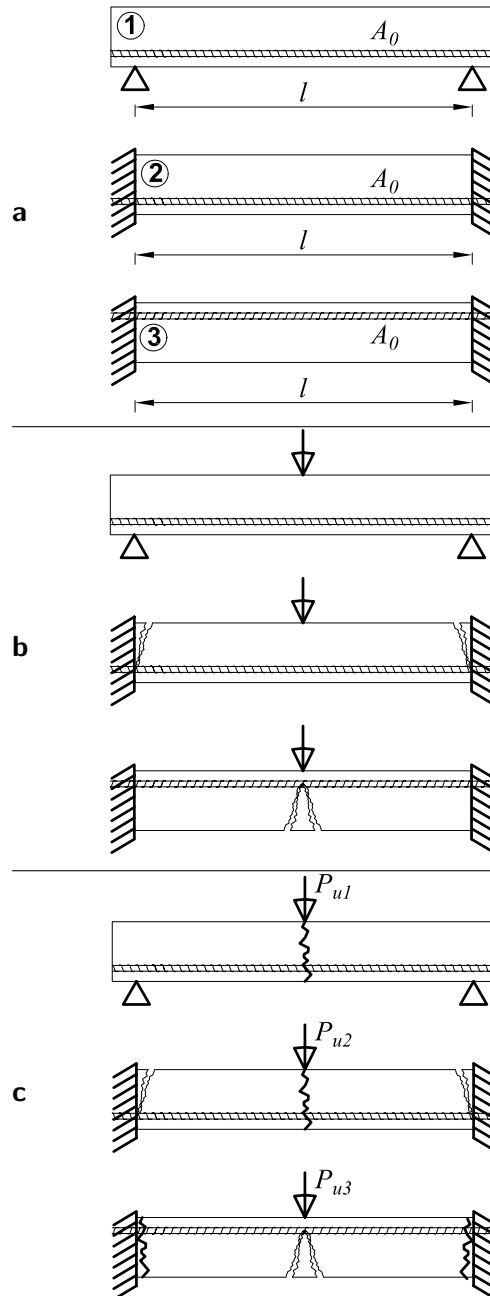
a : Définition des trois poutres de portée l , de même section de béton et armée chacune par une section d'acier A_0 . b : Allure de la fissuration dans les trois poutres pour en début chargement. c Allure de la fissuration à la rupture.
